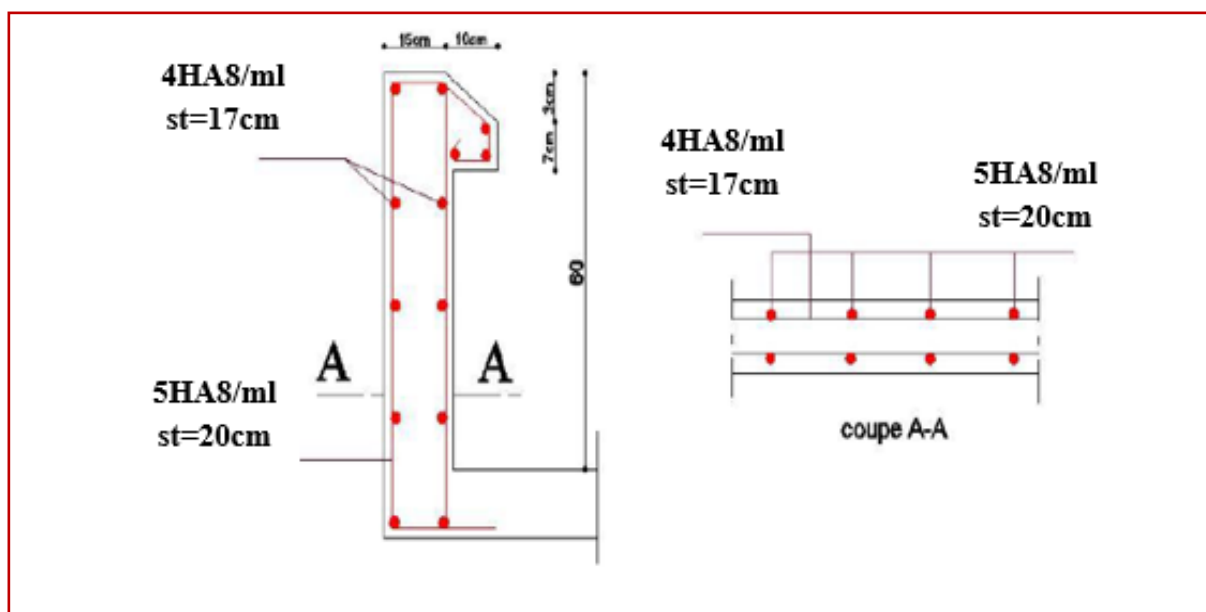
Schéma du ferrailage de l'acrotère Sous la Force Fp
